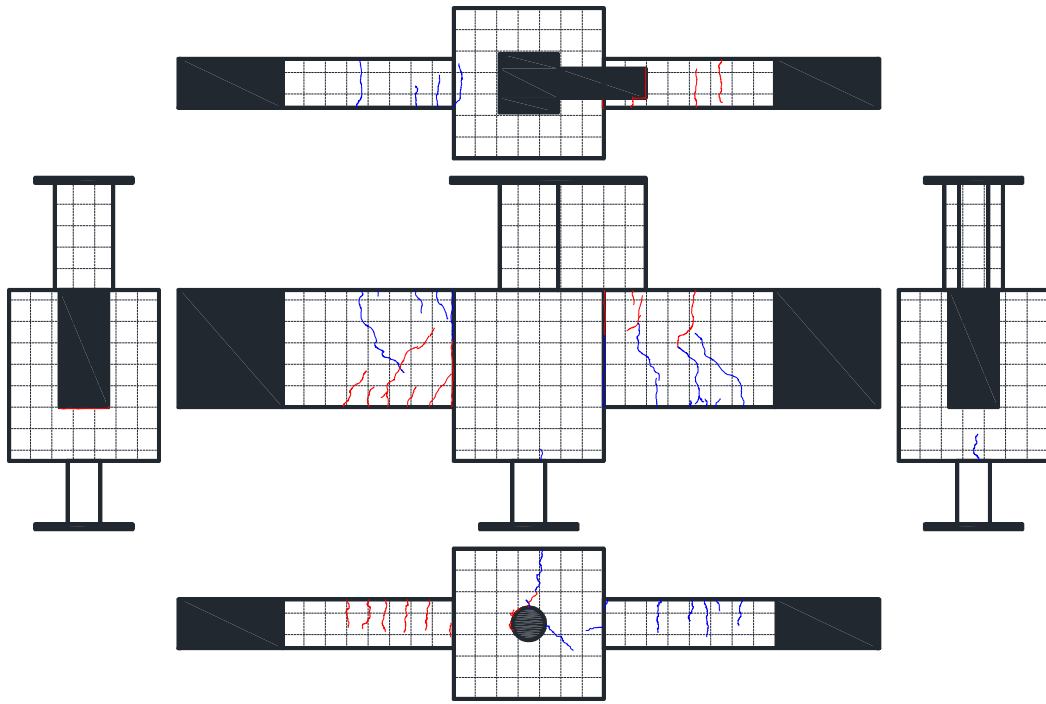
2. 3-55 試験体 DR-5 ひび割れ状況 (2Cycle)
